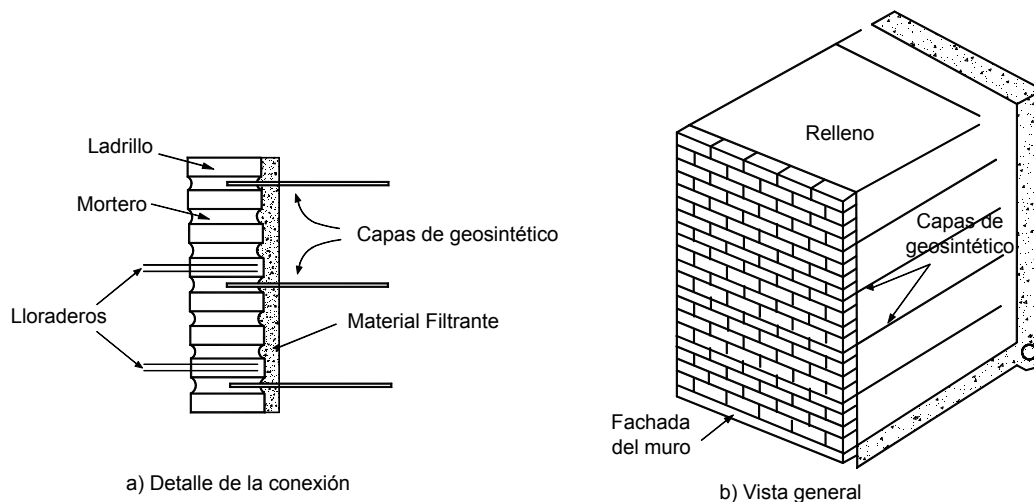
Muro reforzado con fachada en ladrillo (Pinto, 2003).
